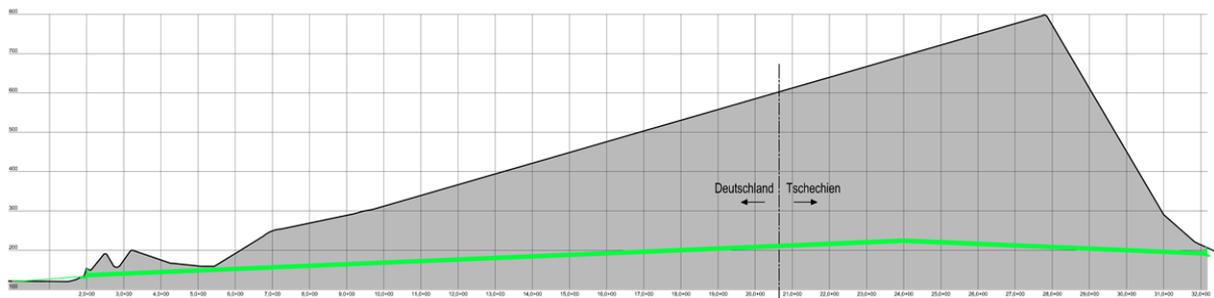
Übersichtslängsschnitt Erzgebirgstunnel, [1]
